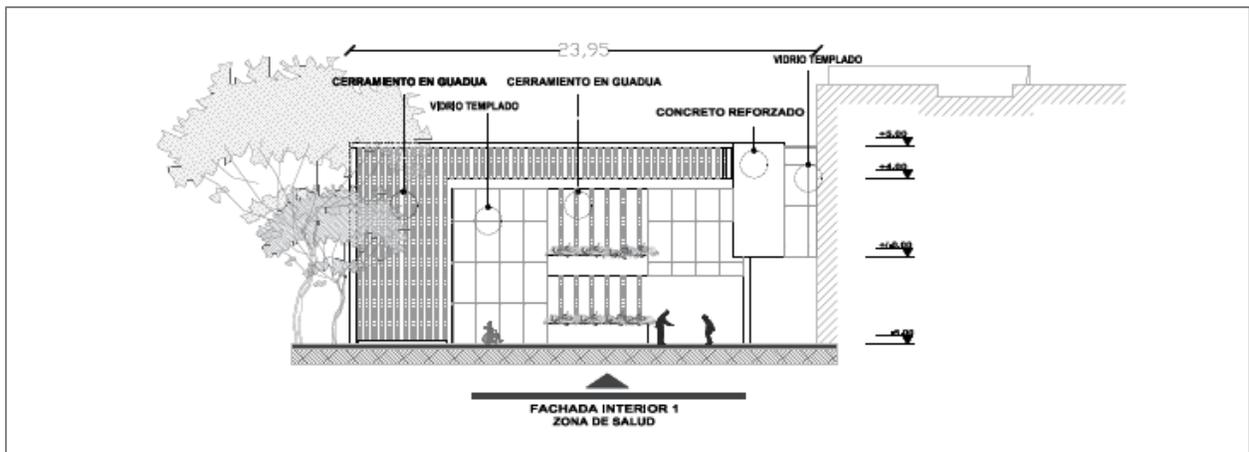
Fachada Interior 1 Zona de Salud (Rubiano, 2020)
